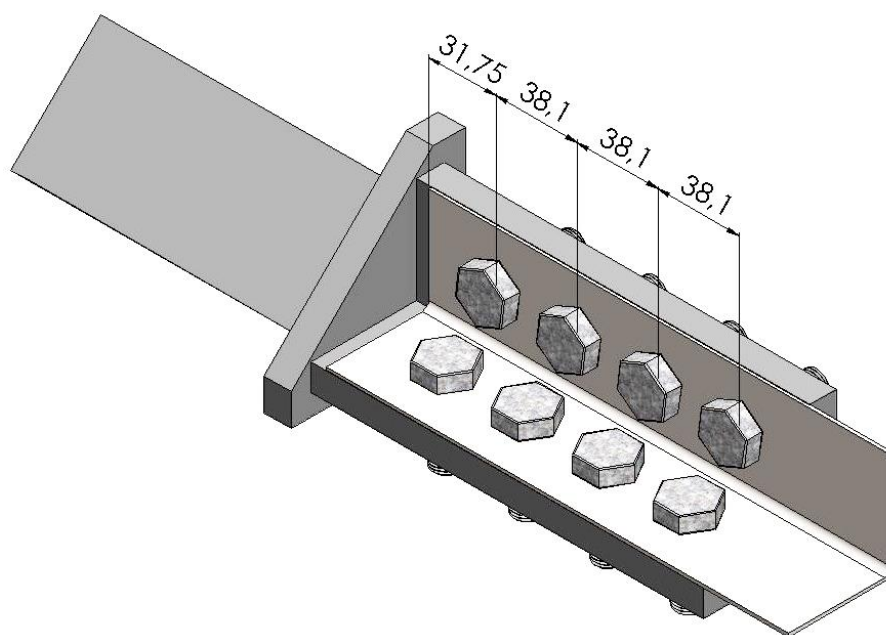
Configuração das cantoneiras conectadas com uma linha de furos por seção, conectadas pelas duas abas, dimensões em (mm).
